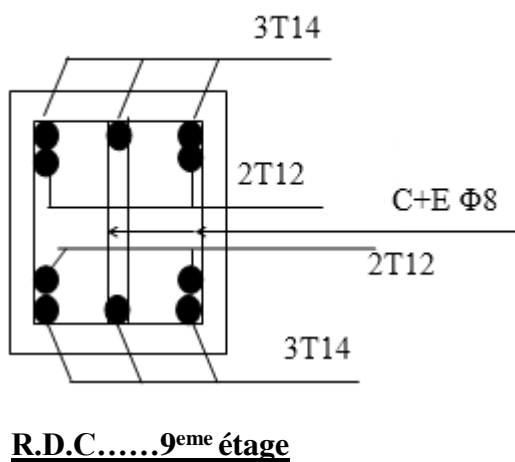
Dessin de ferrailage des sections des poutres secondaires.
